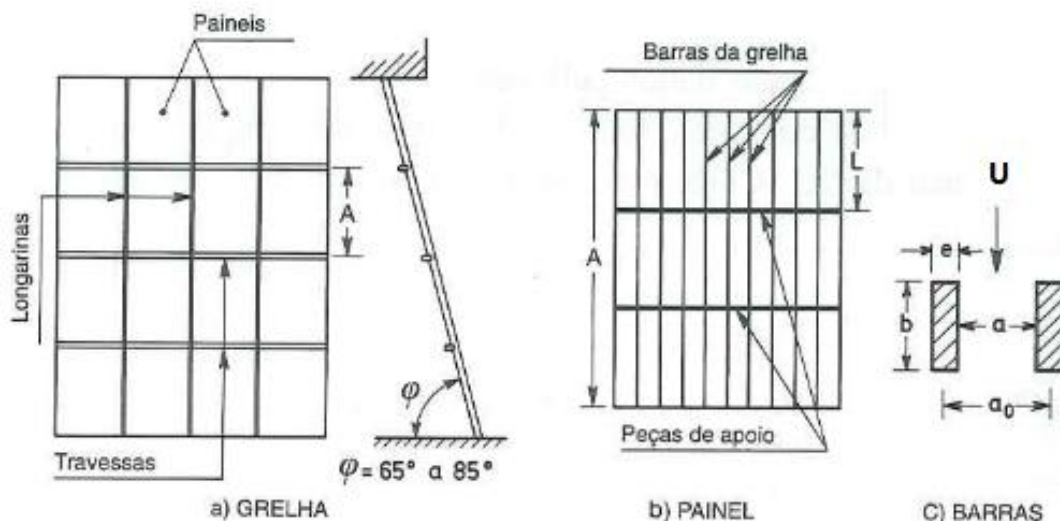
Constituição da grelha, painéis e dimensões em planta das barras (Lencastre, 1996)
